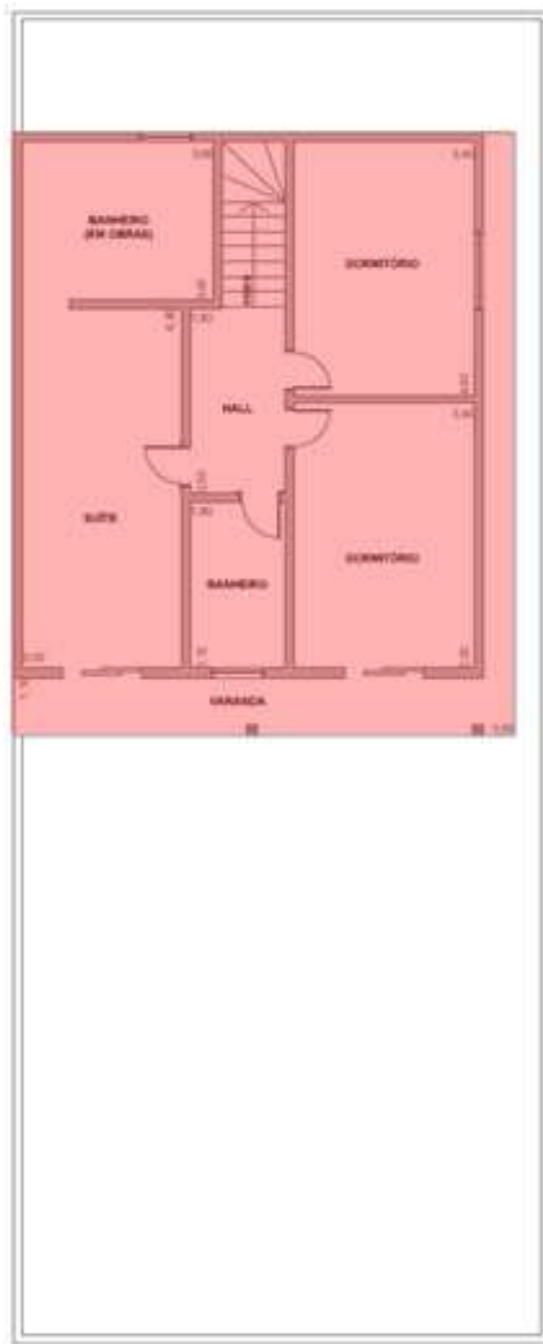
Croqui / Planta da edificação – Elaborada pelo Signatário e considerando os dados coletados “in loco”. PISO INFERIOR.
